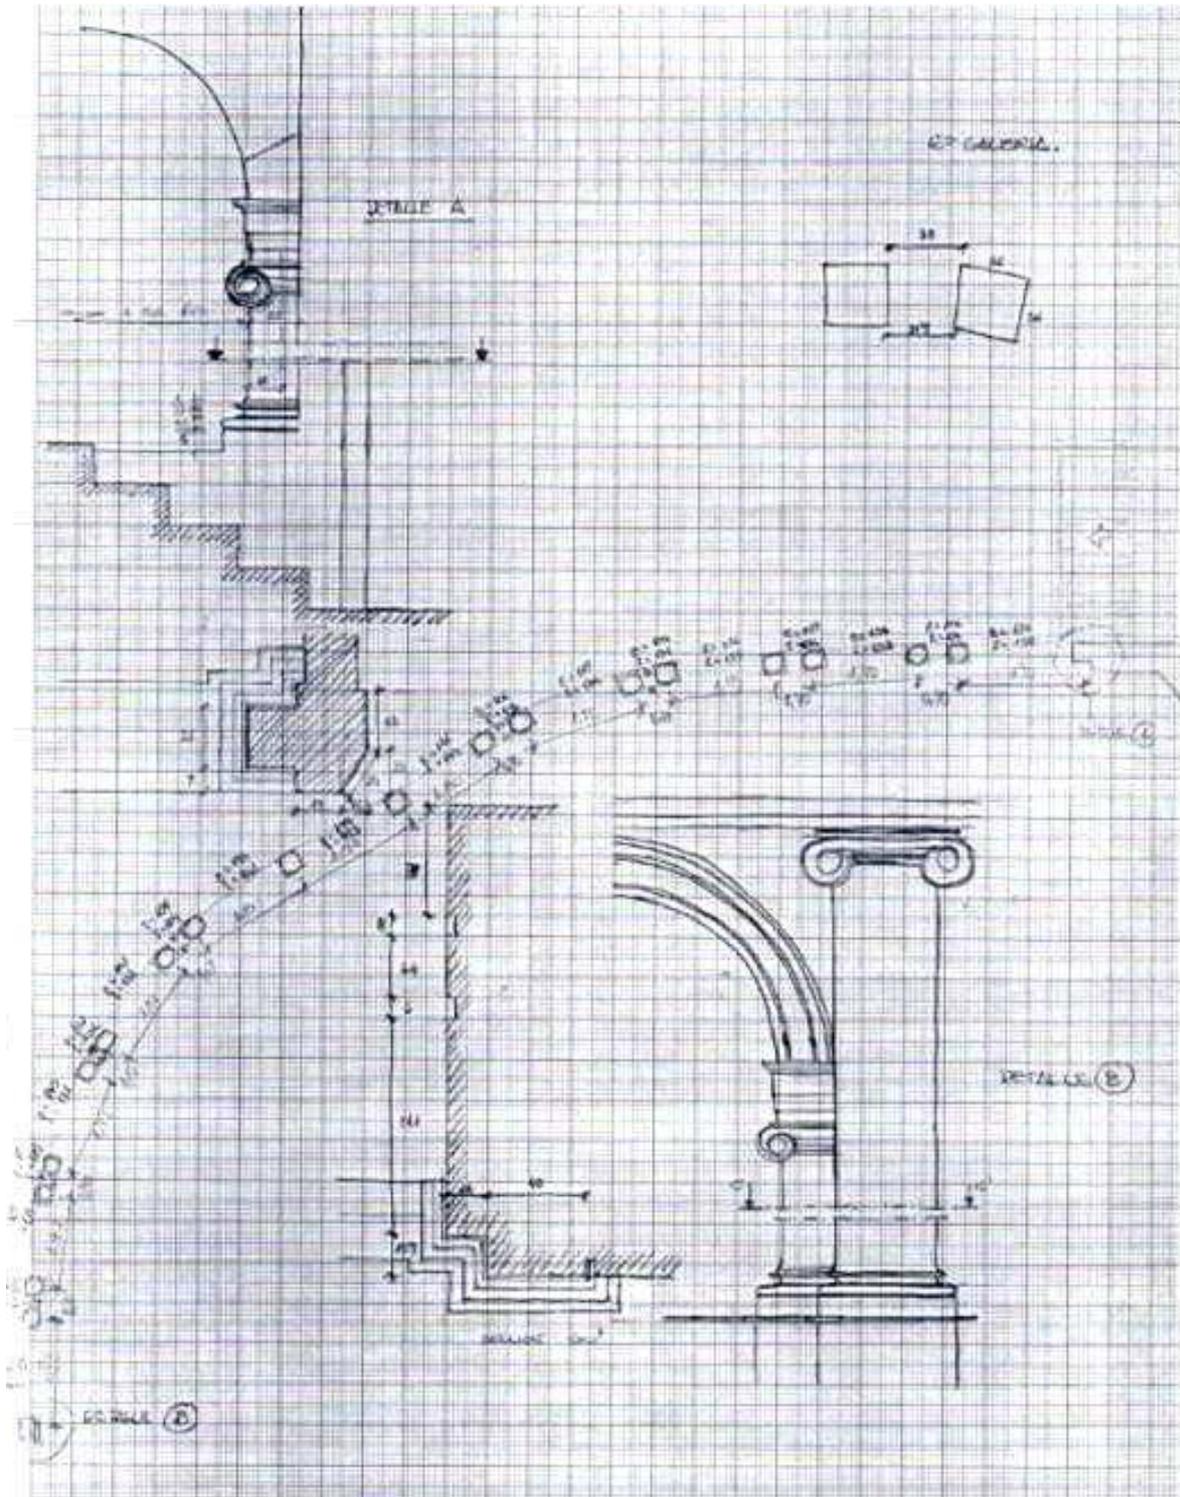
24.4 Toma de datos de elementos de planta primera y segunda.
